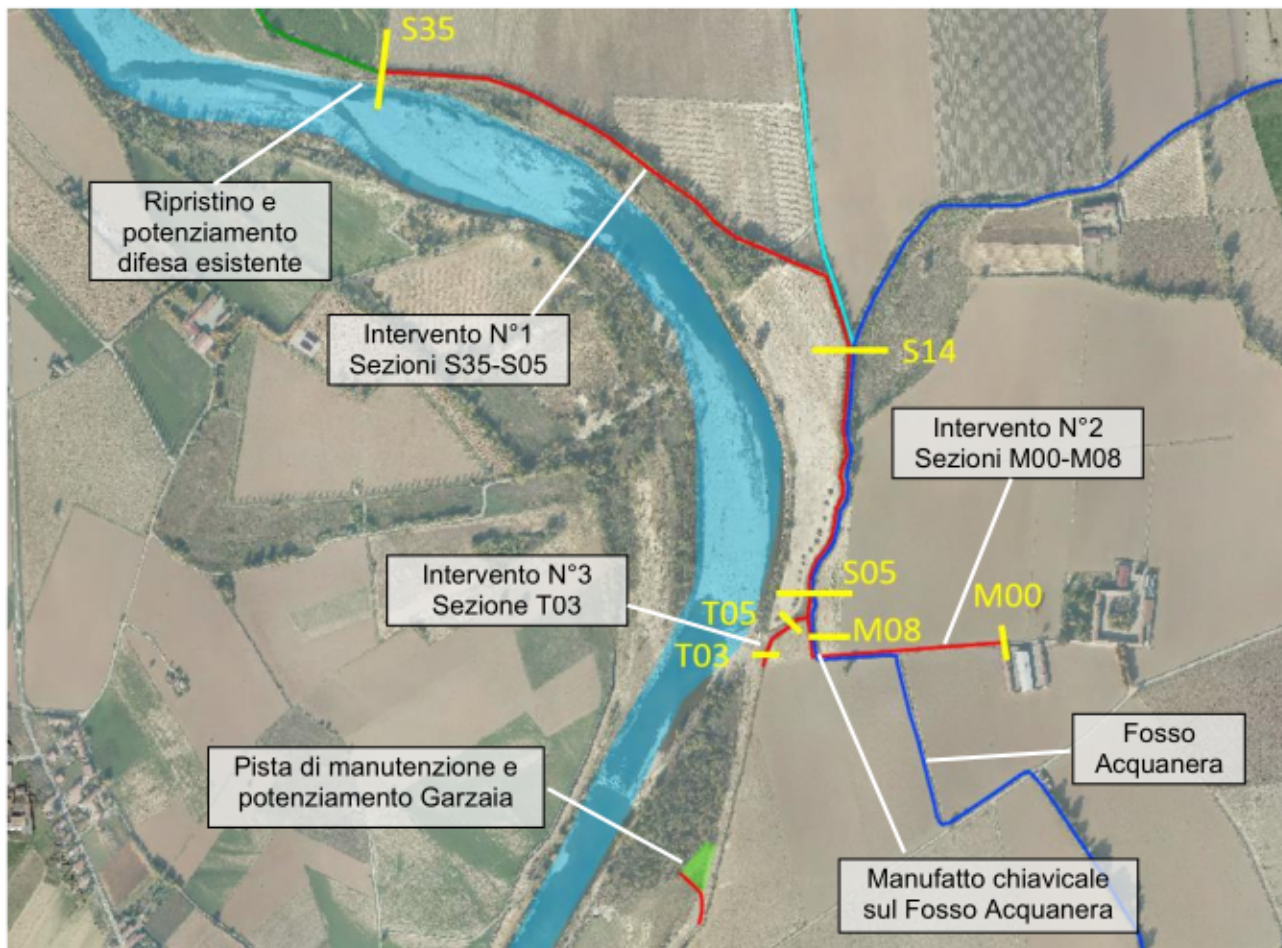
PLANIMETRIA GENERALE DI PROGETTO - MASTERPLAN DELLE OPERE
